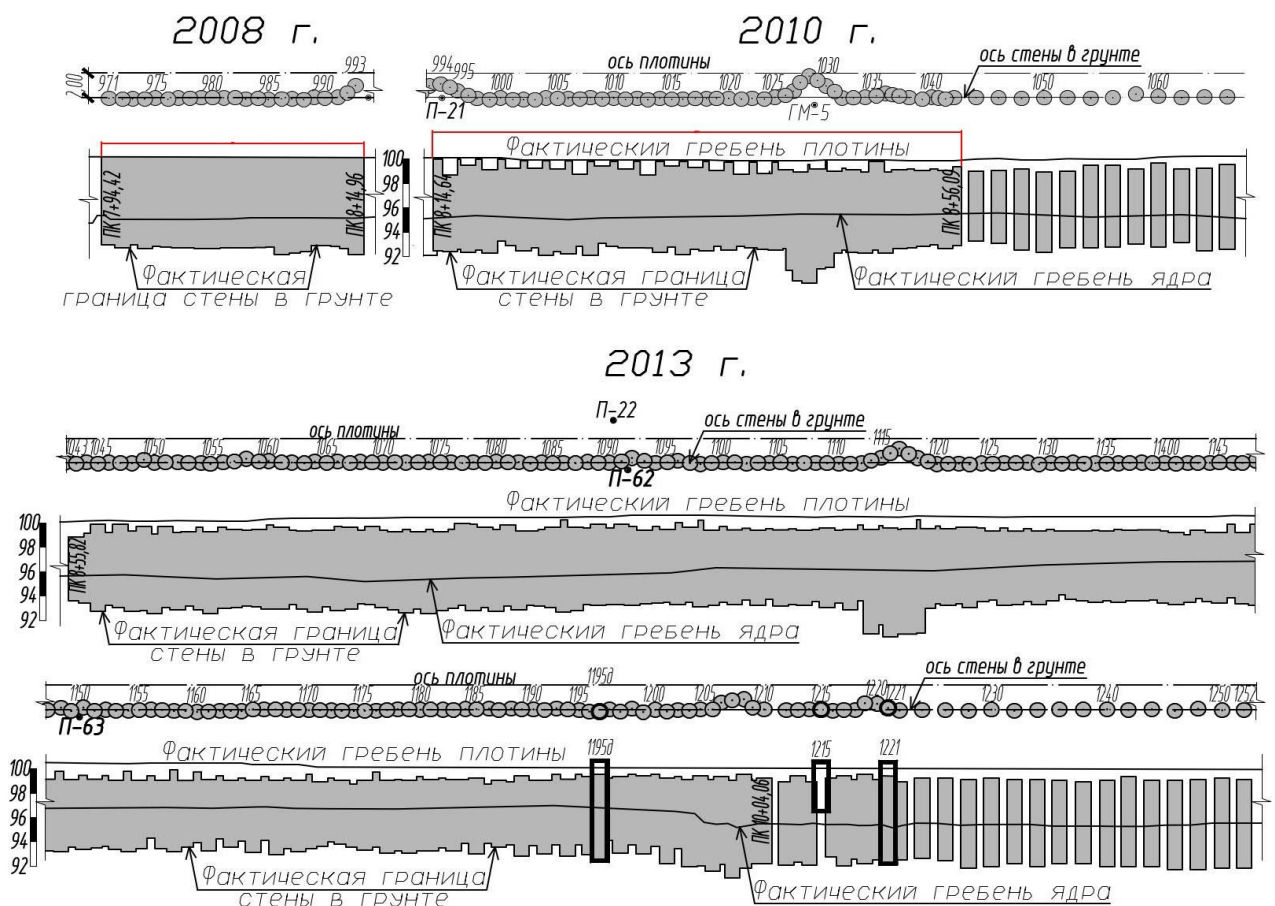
План скважин и продольный разрез по оси стены в грунте на участке ПК 7+94,42...ПК 10+41,68
